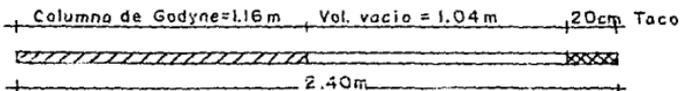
Columna de Godyne en los barrenos de techo y cuaña.
